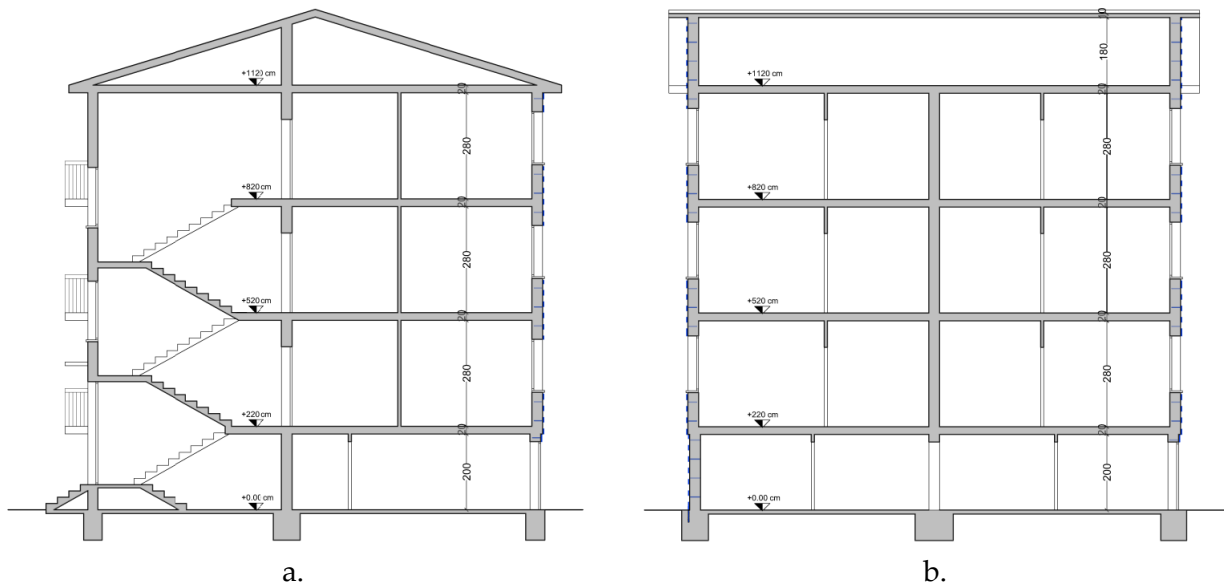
Intonaco armato con rete elettrosaldata su due lati: a) sezione A-A; b) sezione B-B
